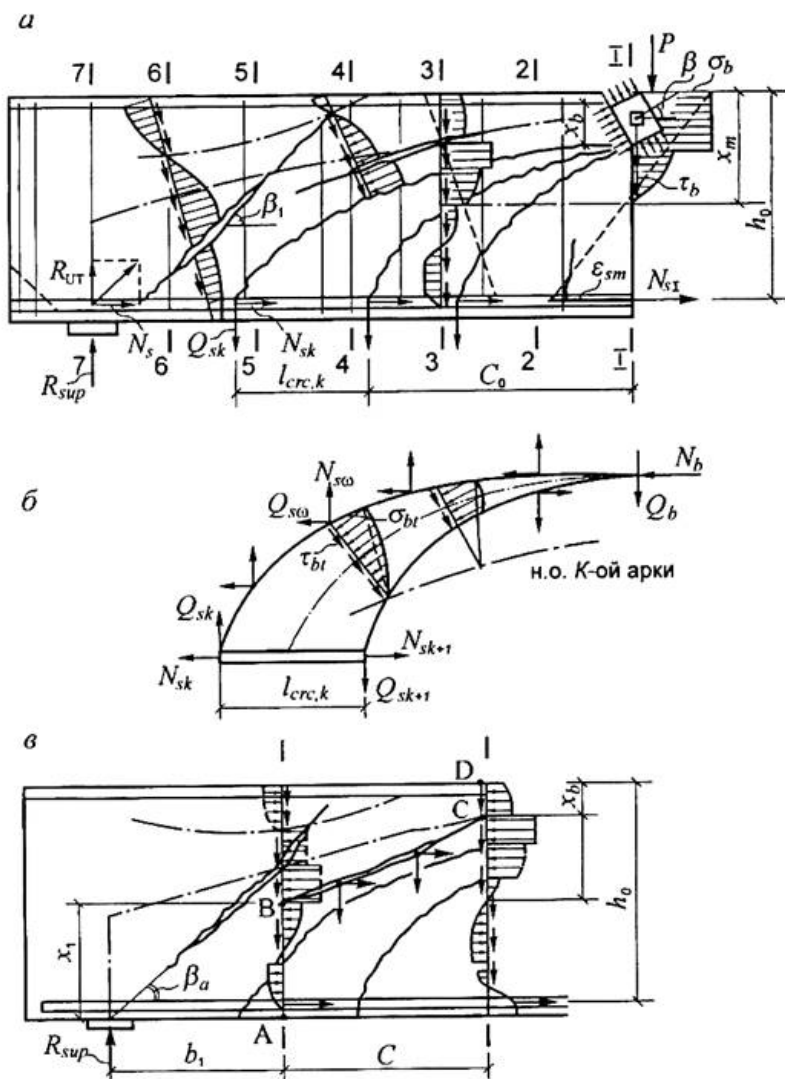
Расчетные схемы арок для определения напряженно-деформированного состояния (НДС), количества и ширины раскрытия трещин, а также жесткости стержневых железобетонных элементов в зоне расчетной модели сопротивления: *а* - схема трещин и НДС; *б* - расчетная схема *k*-ой арки; *в* - расчетная схема для определения ширины раскрытия трещин 3-го типа, образующихся в арках
